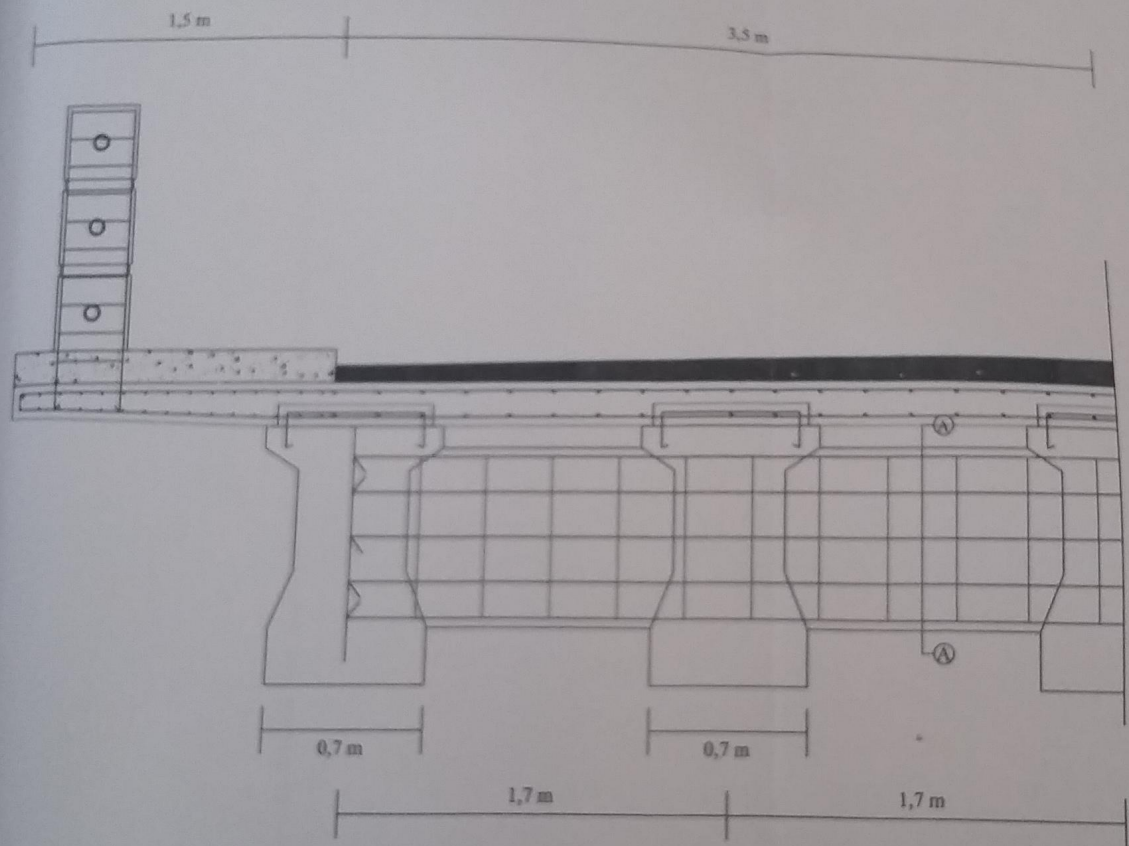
DETAIL PENULANGAN TIANG SANDARAN DAN PLAT KONTILEVER
